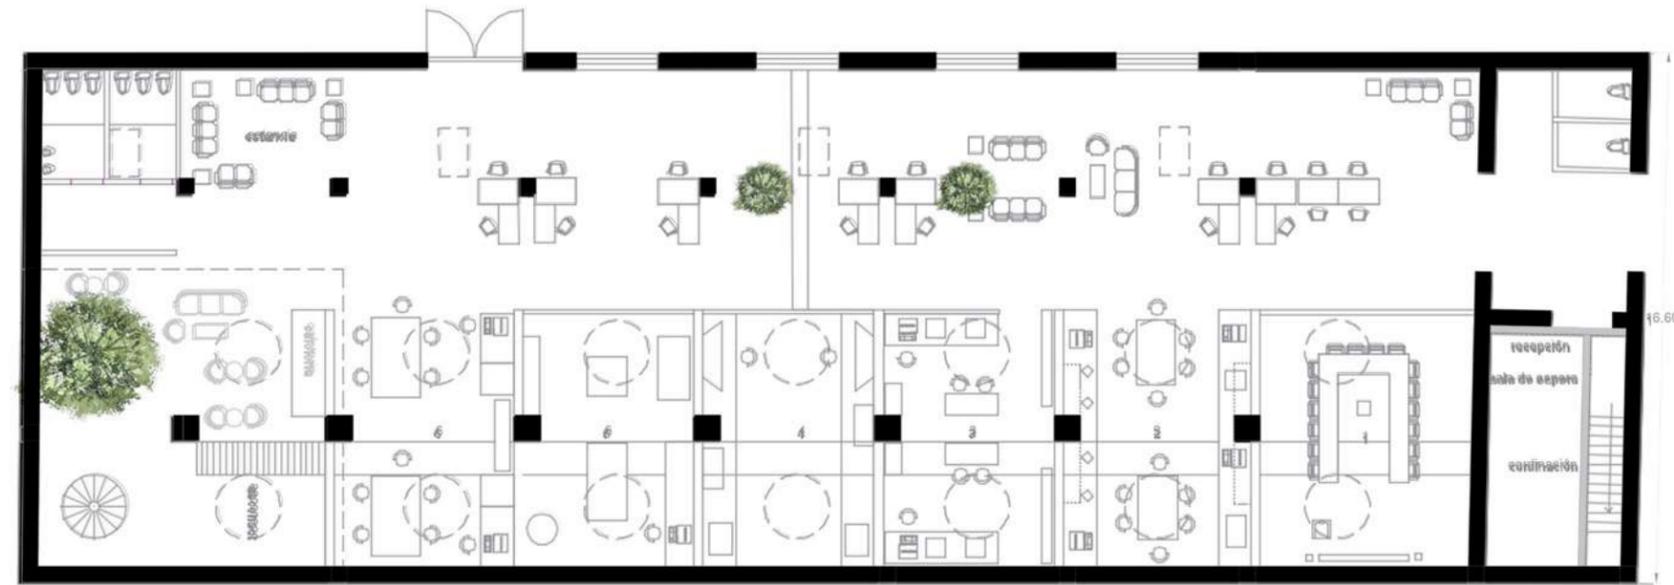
Planta arquitectónica de la nave existente a la fecha de hoy
